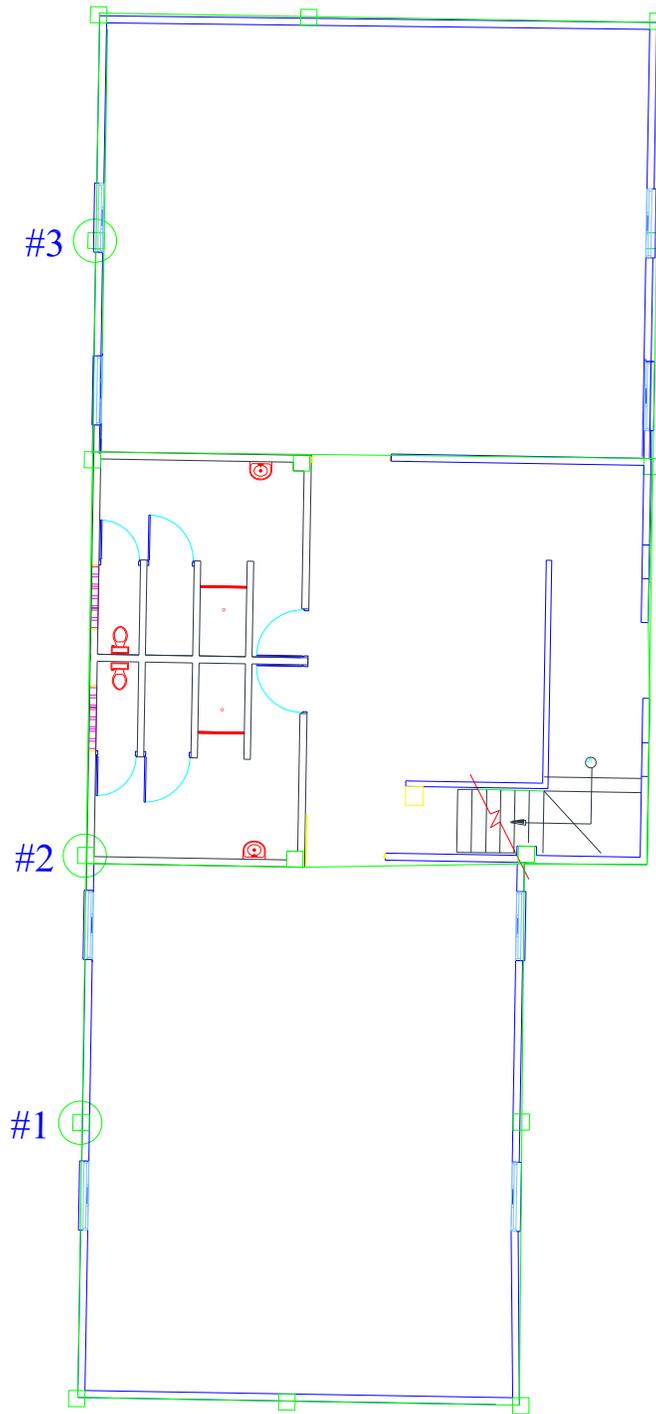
Ensayos en columnas de bloque B9 – Bellas Artes.
